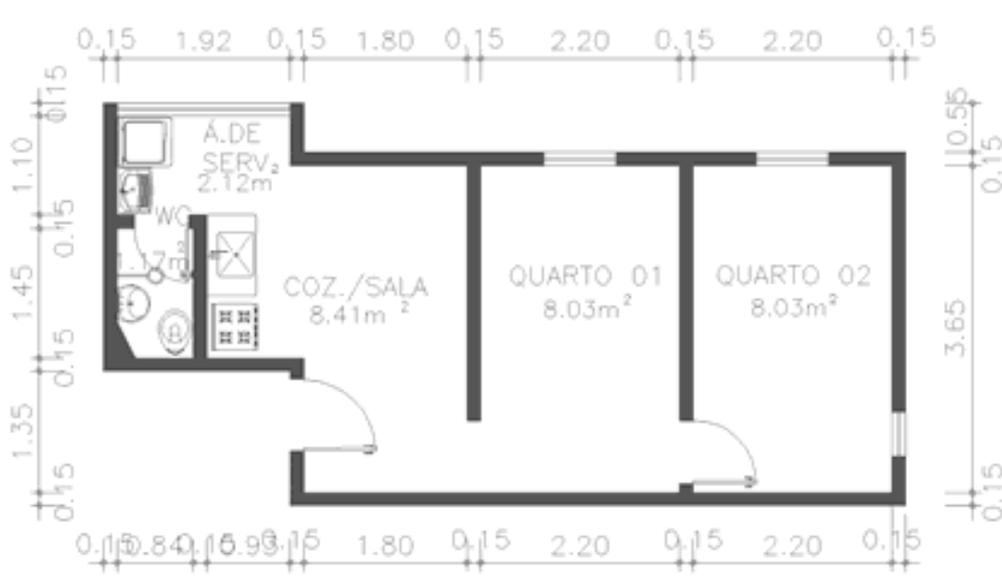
QELC 01, Bloco B1 e B9 - Planta Original
